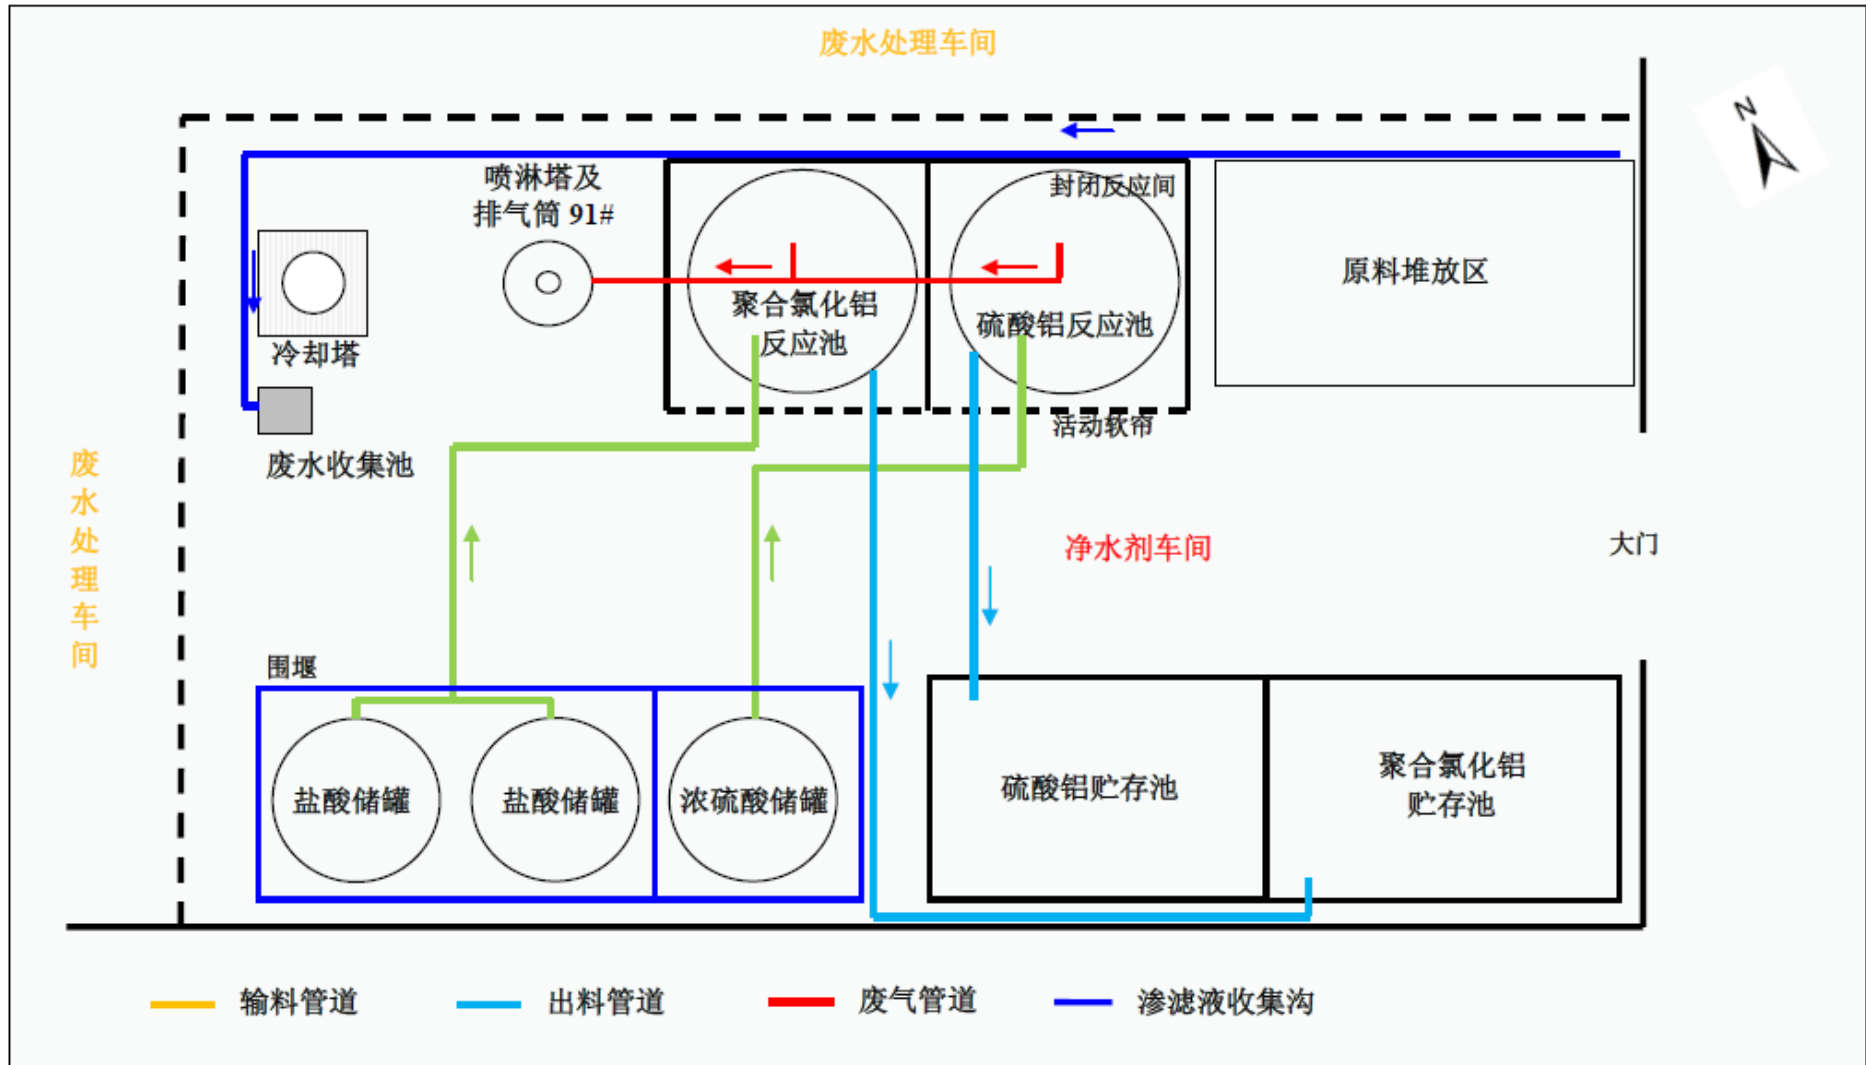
本次技改项目净水剂生产车间平面布置图
